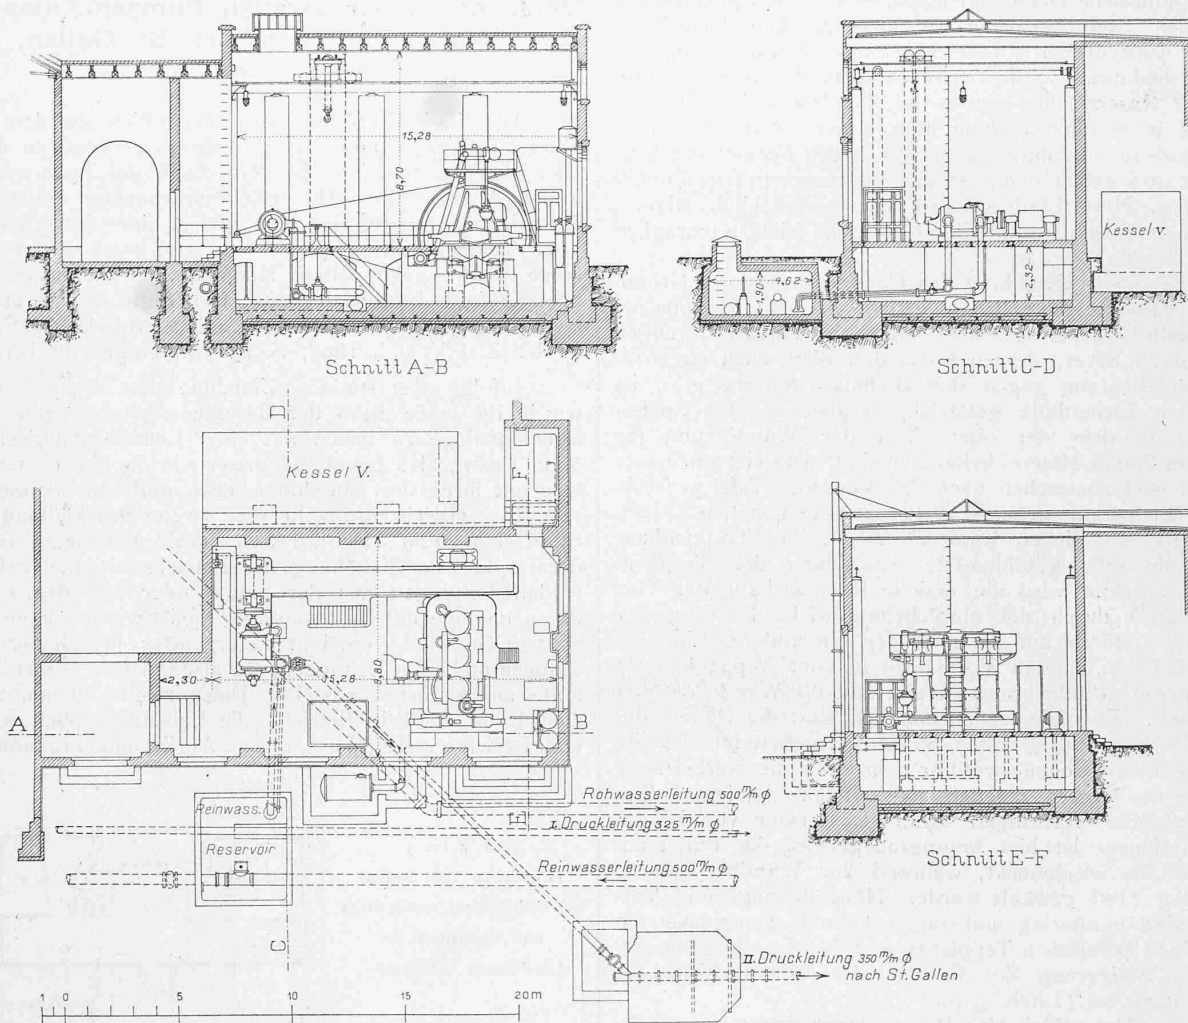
Erweiterung der Pumpen-Anlage im Riet in Rorschach; Grundriss und Schnitte des Motorengebäudes. — 1 : 300.
